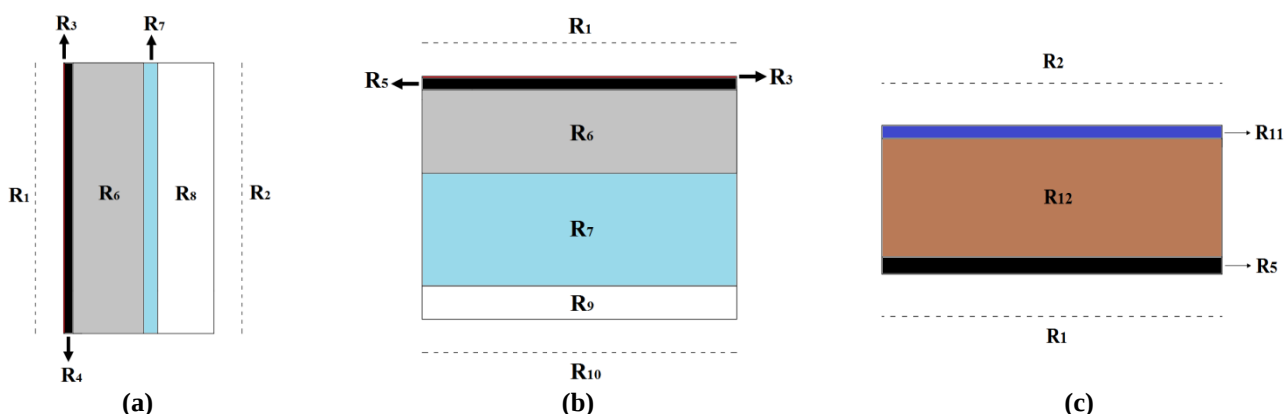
Construção das estruturas internas e externas do bloco cirúrgico. (a) Parede, (b) Laje, (c) Piso.
